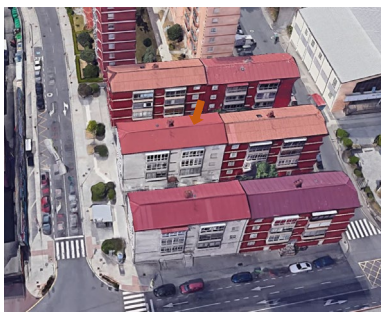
Vista aérea de la fachada Eeste del edificio situado en la Rúa Vilagarcía - Arousa, 6.
